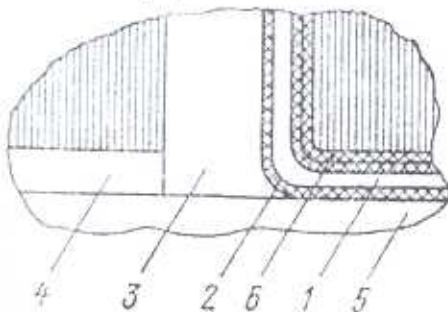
Укладка провода в месте выхода в вентиляционный канал [1]:
